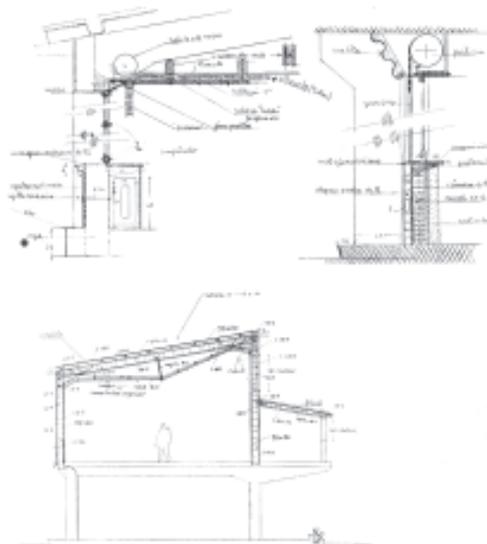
Instituto Laboral. Detalles constructivos y sección.
